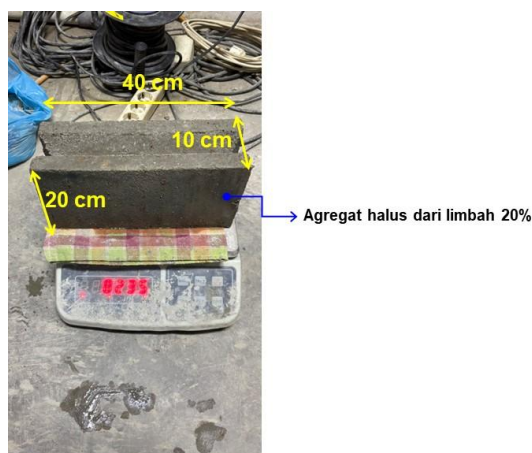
Proses pembuatan prototipe batako, paving block dan benda uji beton precast saluran
